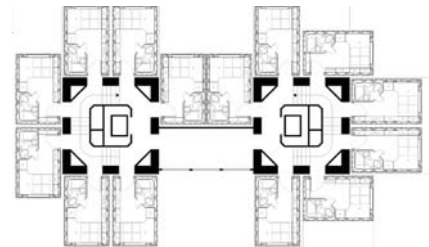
Planta edifici Nakagin Capsule Tower.
